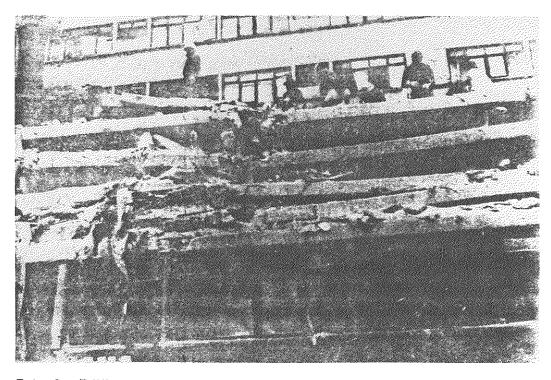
Edificación de 12 pisos construída mediante el uso de muros de corte o pantallas y losas de concreto armada con colapso total de los 6 pisos superiores durante el terremoto de México, originado por la baja calidad de las juntas. (foto Salvatierra)
